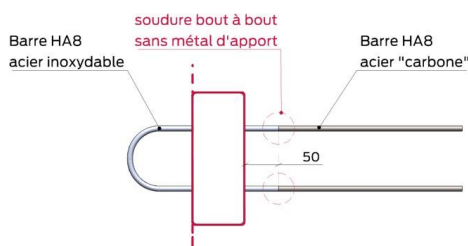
Schéma des barres d'armatures longitudinales et position de la soudure – Exemple modèle ZA dalle pleine – façade
